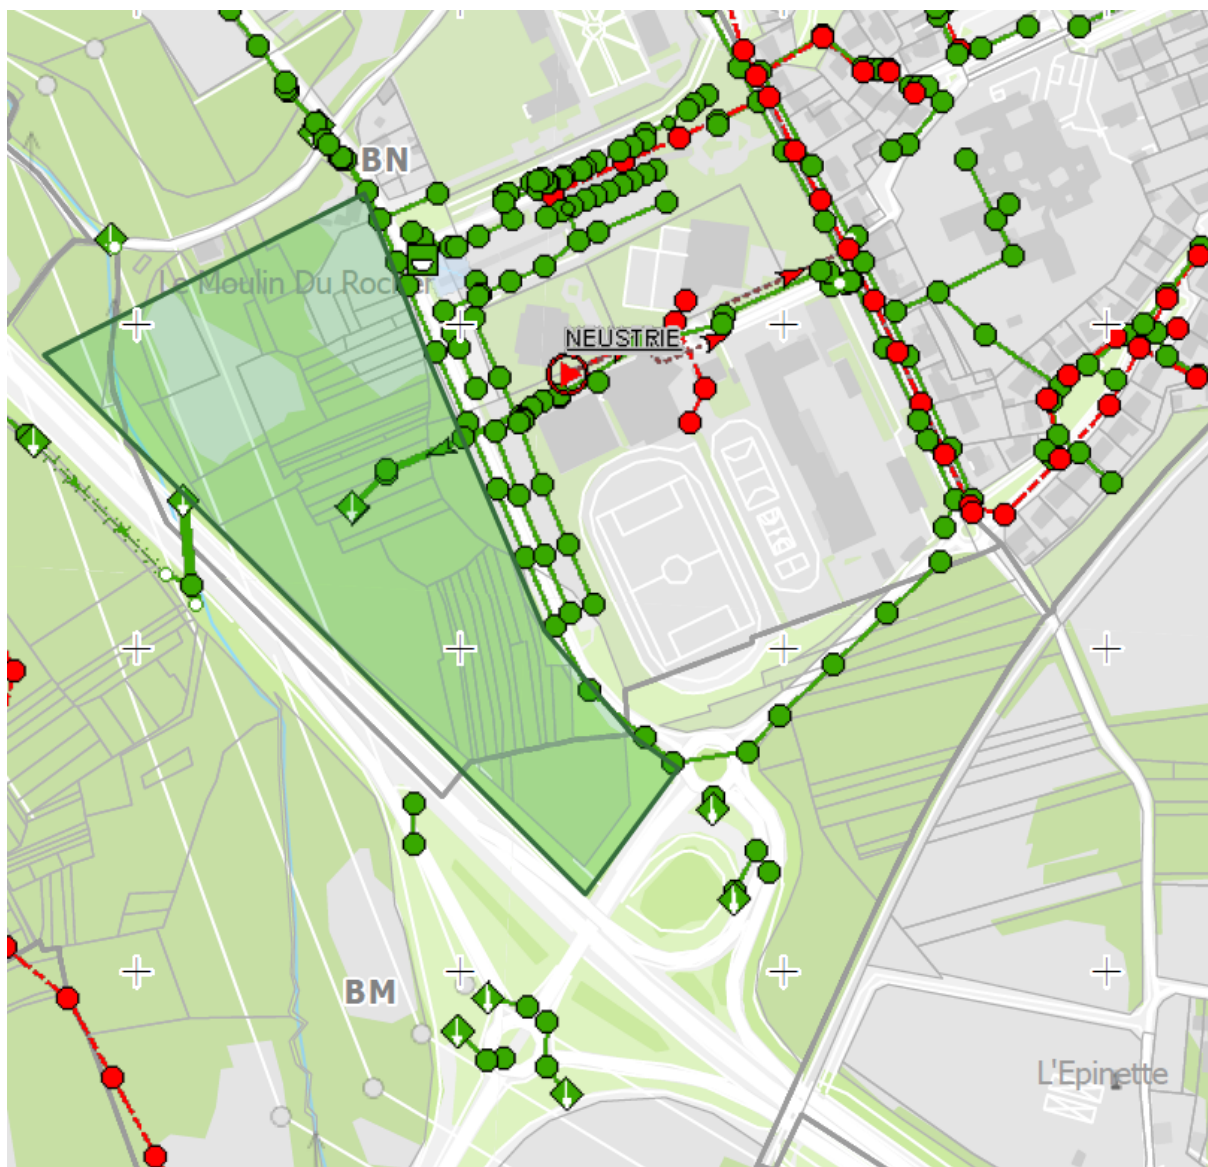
Extrait du plan d'assainissement (source : Nantes Métropole)
